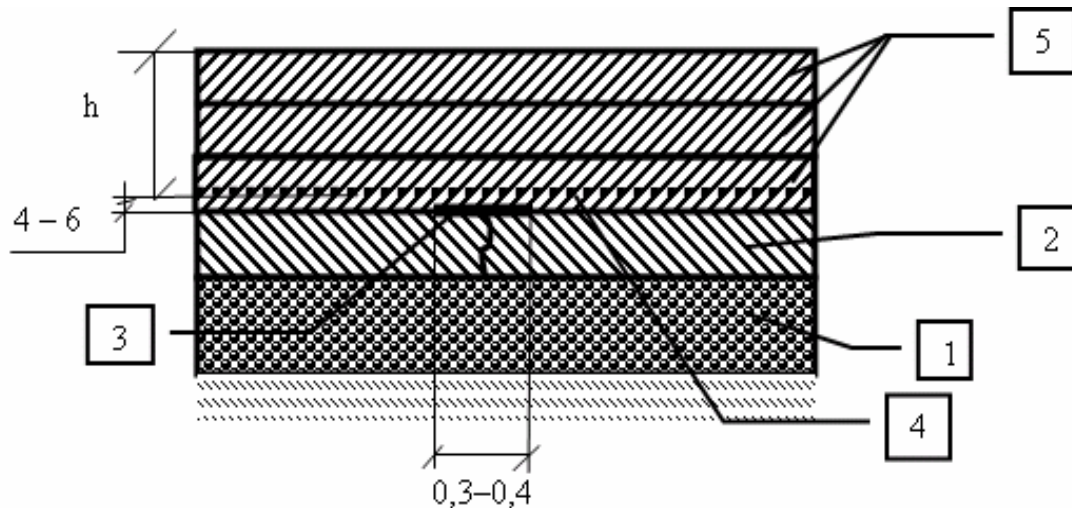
Конструкция армирования асфальтобетонного покрытия на жестком основании:
